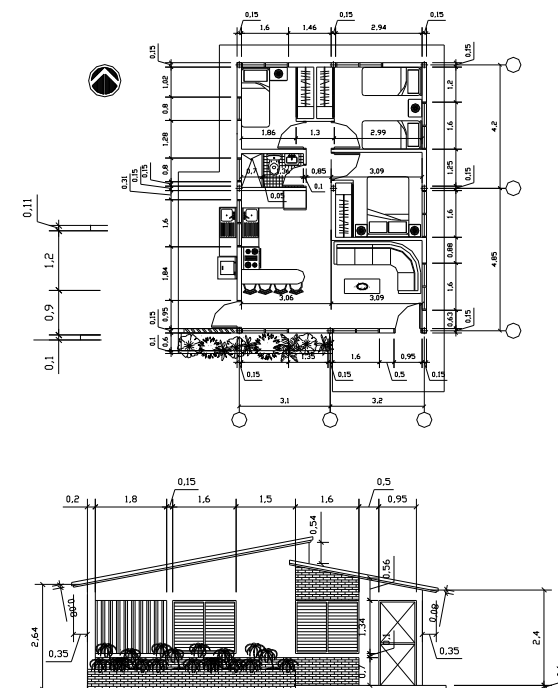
Planta y fachada sur (principal) de vivienda propuesta.
